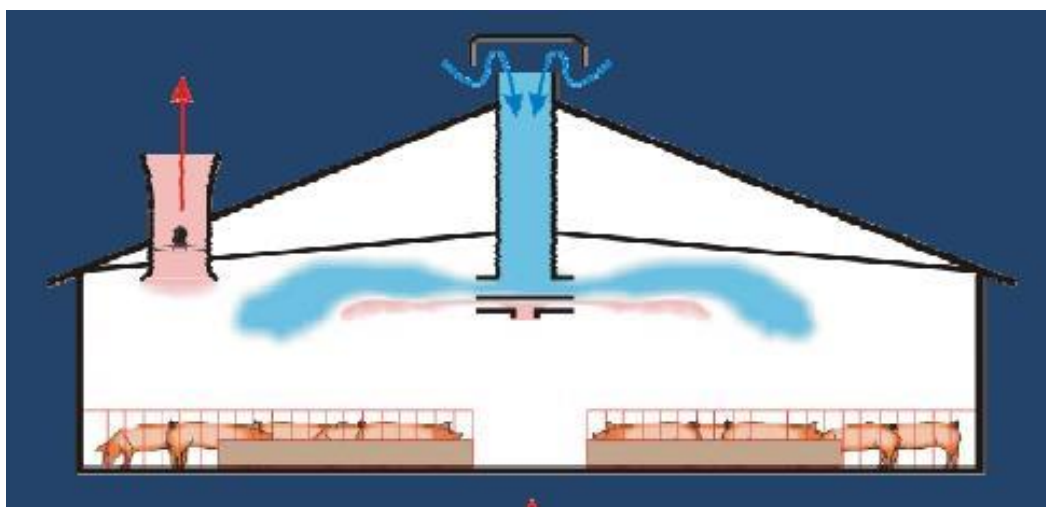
Вентиляция с притоком и вытяжкой воздуха через крышу
